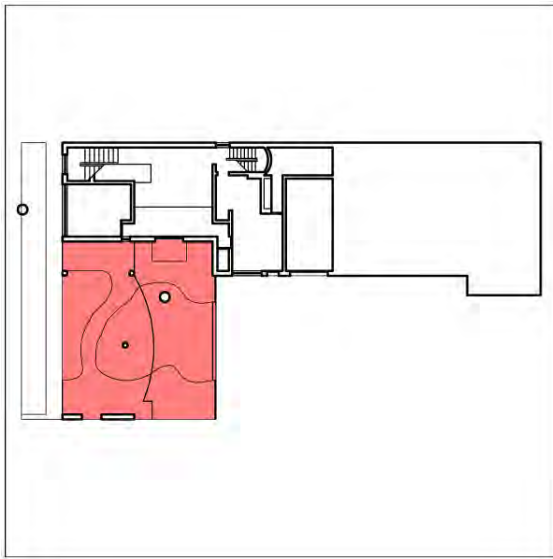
Vila La Roche, Panta de Localização da zona de entrada (Ilustração nossa)
